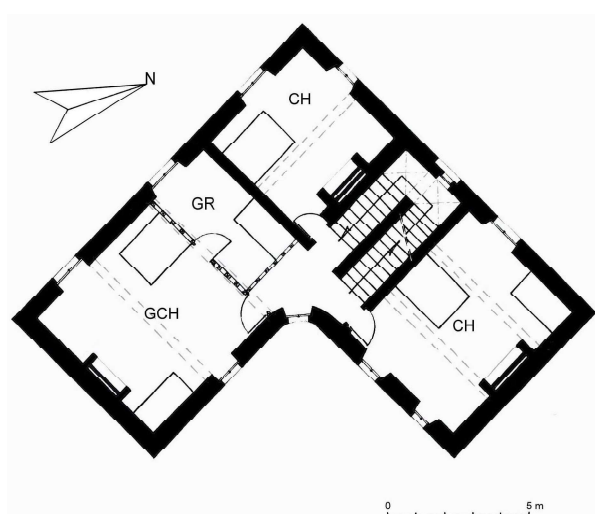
Jouveaux. Plan restitué du premier étage vers 1590.
